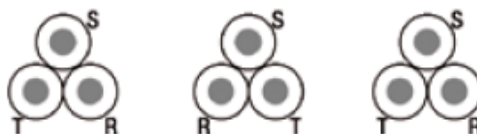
Colocación de cables en tresbolillo directamente enterrado.
